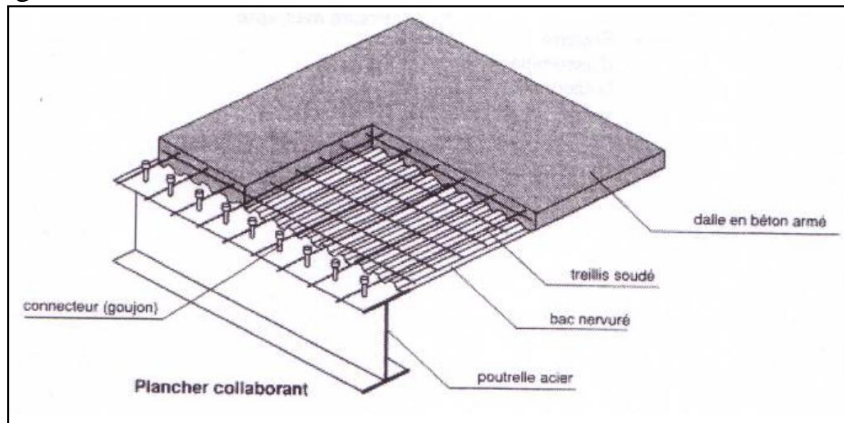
Détail n°3 plancher collaborant , Source : Auteurs
